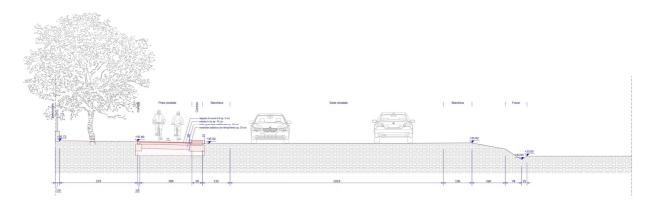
sezione stradale tipo di fronte a Pegeout
